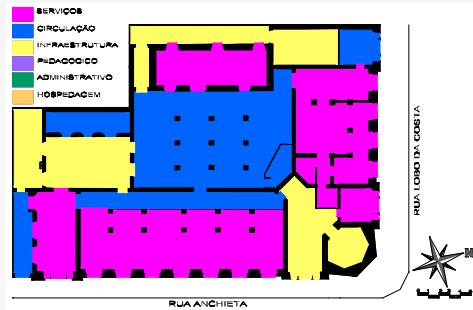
Zoneamento / Planta Baixa Subsolo.
